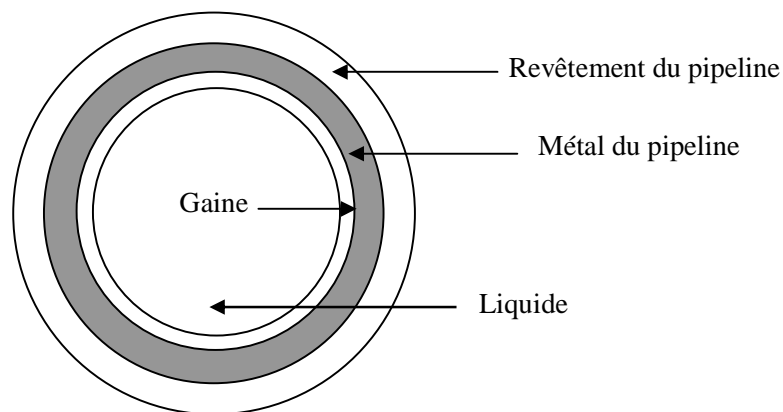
Illustration d'une coupe transversale d'un pipeline
